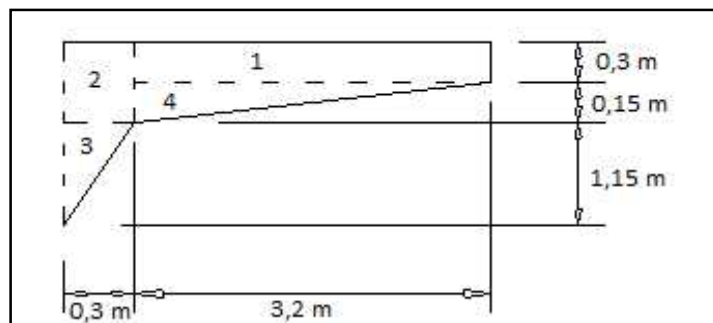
Coupe transversale de l'encorbellement.
